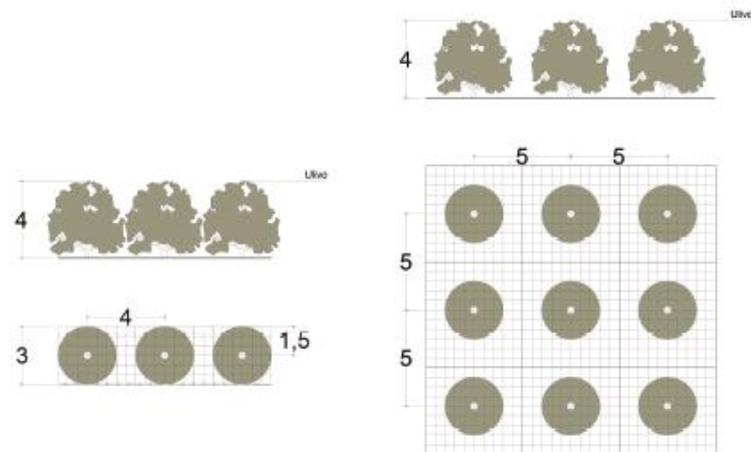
STRALCIO ELABORATO SIL-PDT11
